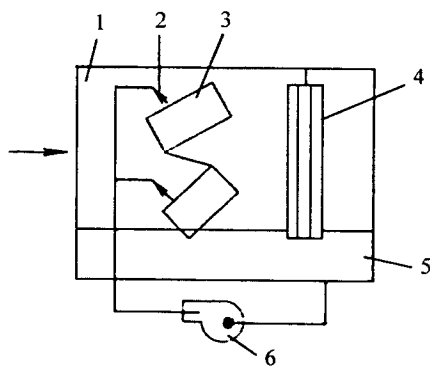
Схема капілярного промивача: 1 – корпус; 2 – форсунки;
